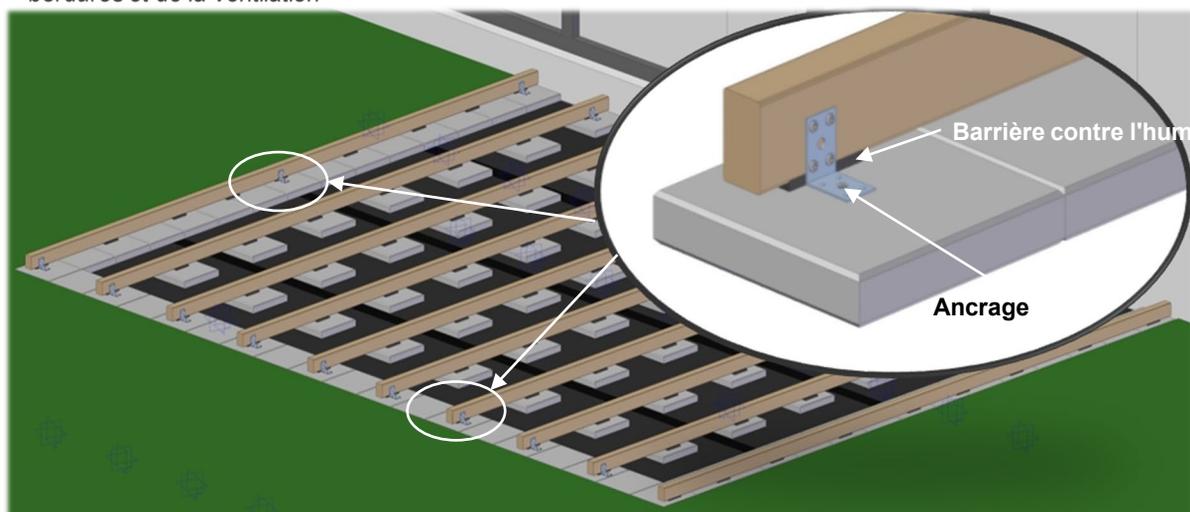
Exemple de poutres au niveau du sol. Les poutres sont montées sur des dalles en béton avec des entretoises en EPDM. Ceci agit comme une barrière contre l'humidité et surélève les solives au-dessus de la dalle de béton, empêchant l'évacuation de l'humidité et permettant un meilleur séchage du bois. Des équerres sont utilisées pour ancrer et rigidifier les poutres.
